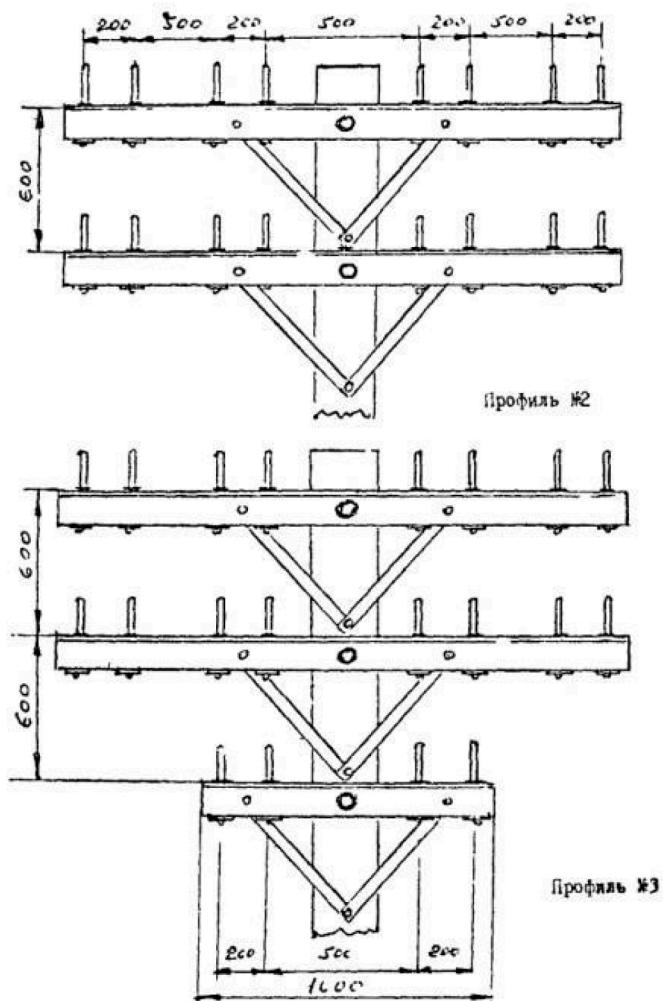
Профили № 2 и № 3 для линий связи на железобетонных опорах типа ТУ-45-УССР-79
